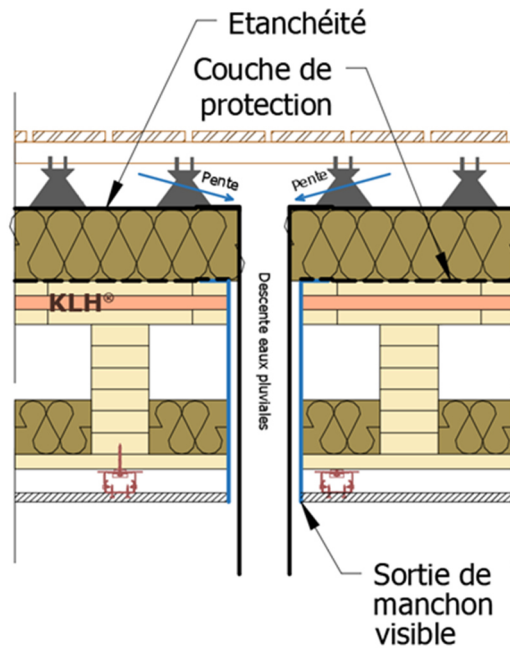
Dispositif de contrôle de fuite au niveau des descentes des eaux pluviales en terrasses accessibles aux piétons et au séjour
